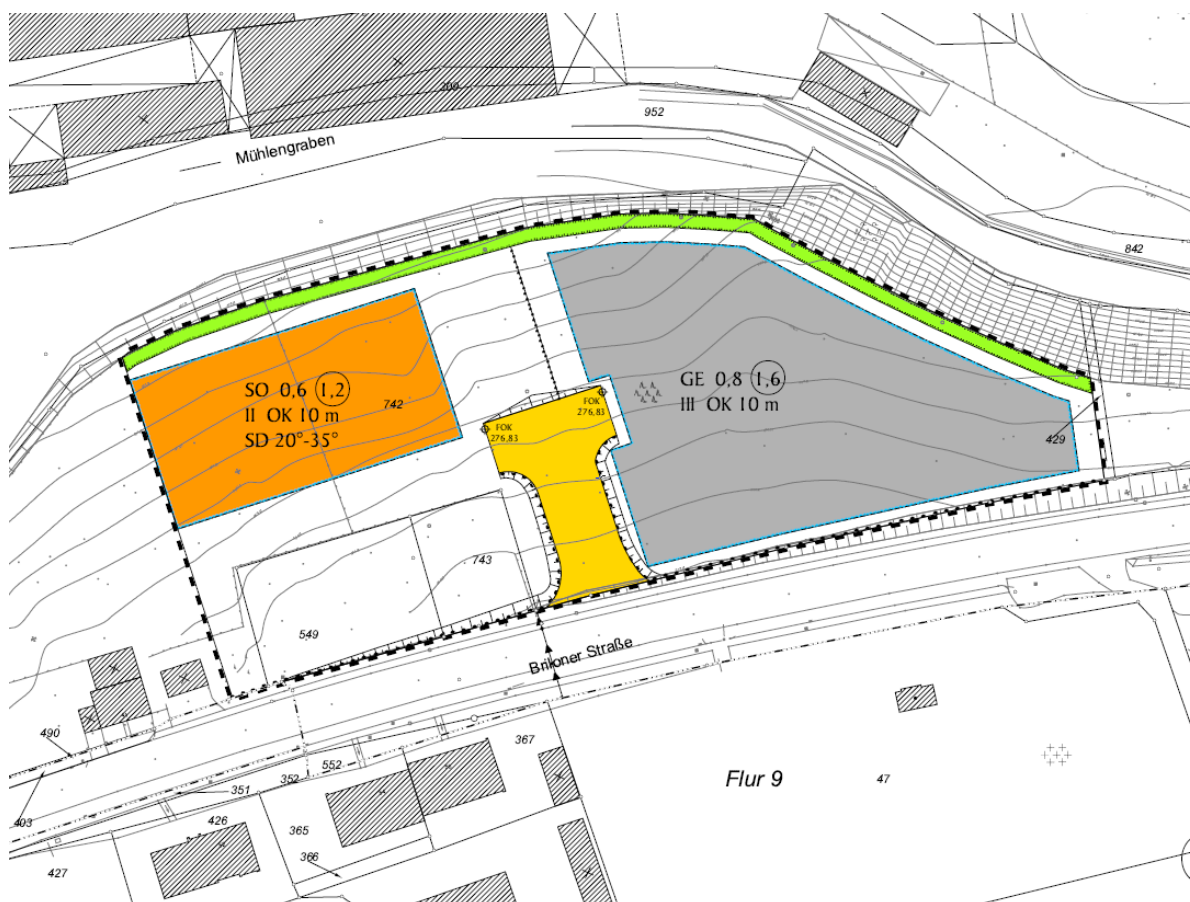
Auszug Bebauungsplan Nr. 139 „Briloner Straße“
